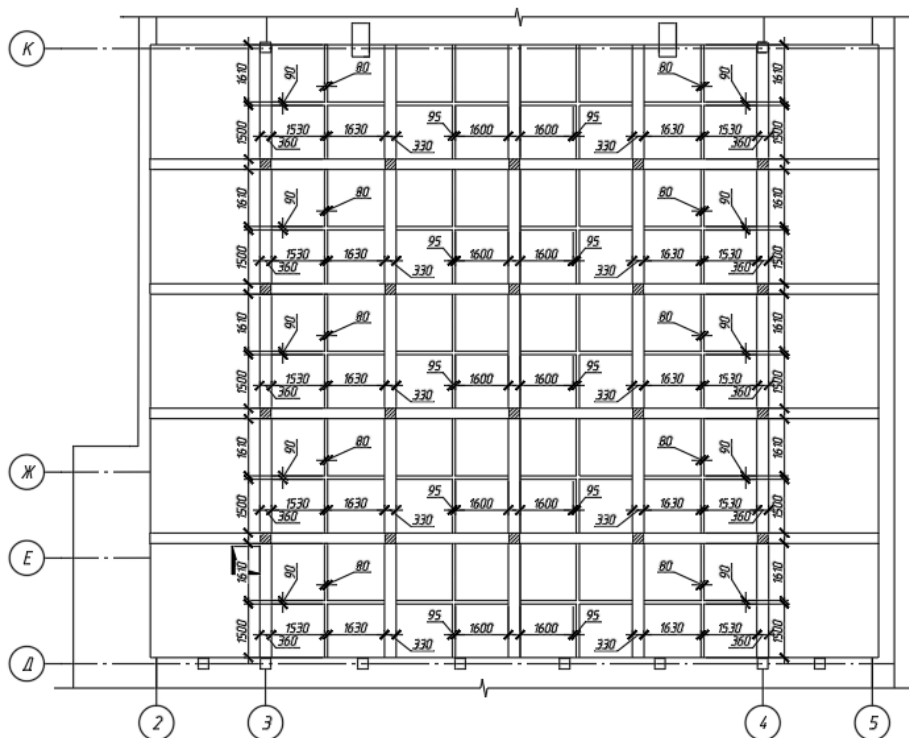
Схема залізобетонної монолітно-ребристої плити перекриття в осях 2-5/Д-К
